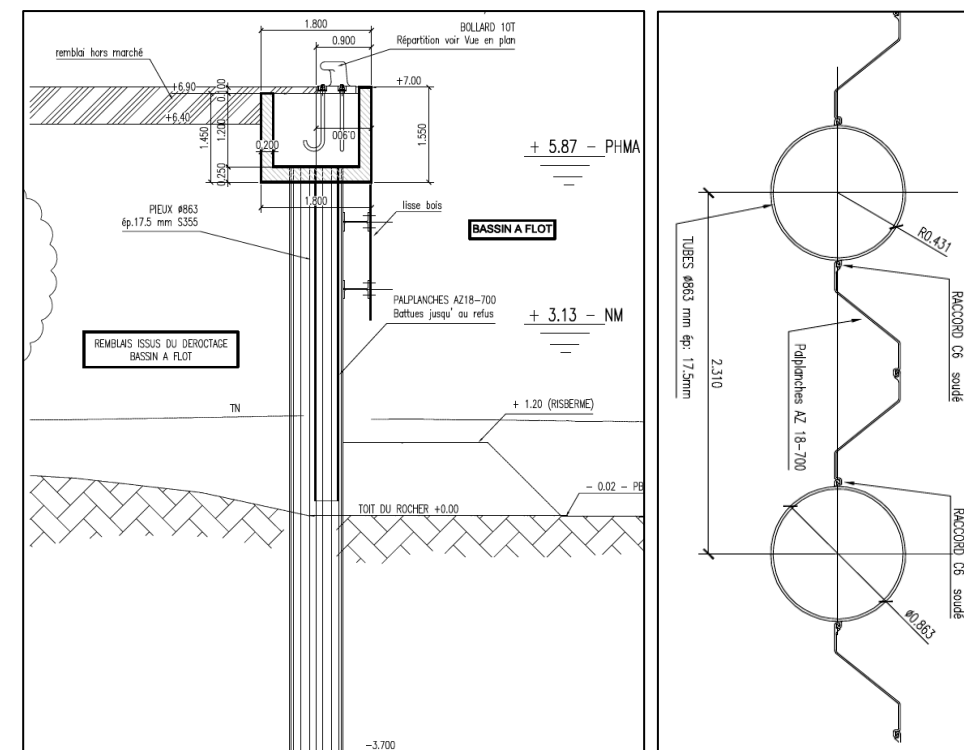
Principe d'un combiwall autostable – Port Haliguen.
